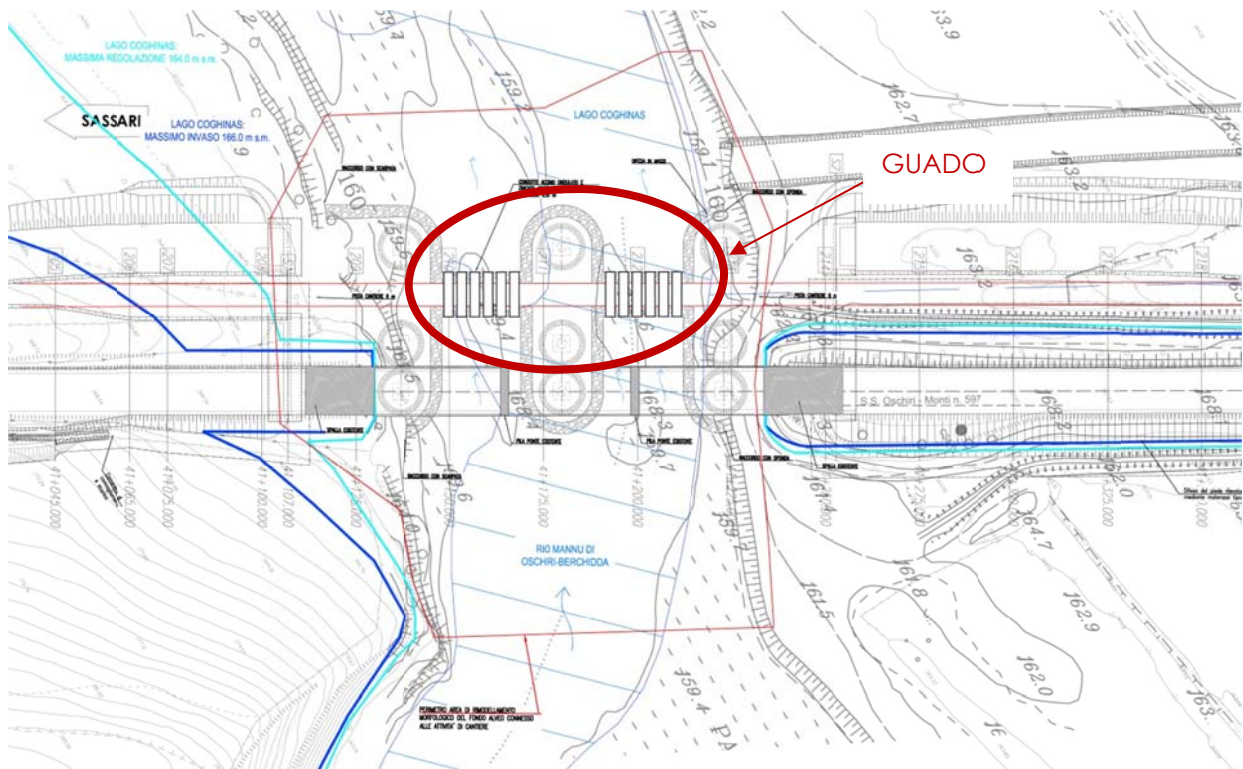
Planimetria con l'ubicazione del guado provvisoriale
